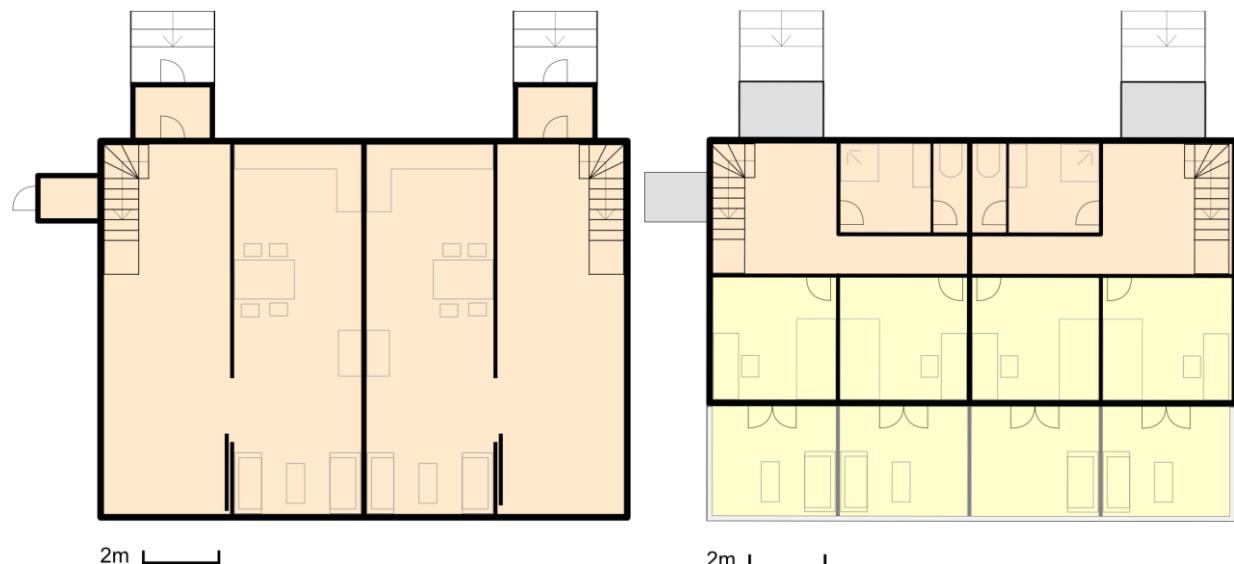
Plan du rez-de-chaussée d'une unité d'habititations
